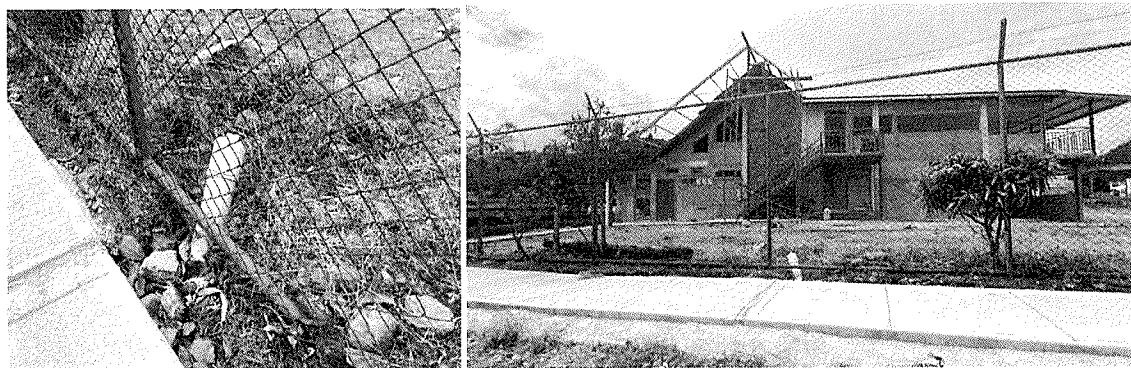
Conexión a la red de alcantarillado sanitario. Fuente: Equipo consultor, 2024.
